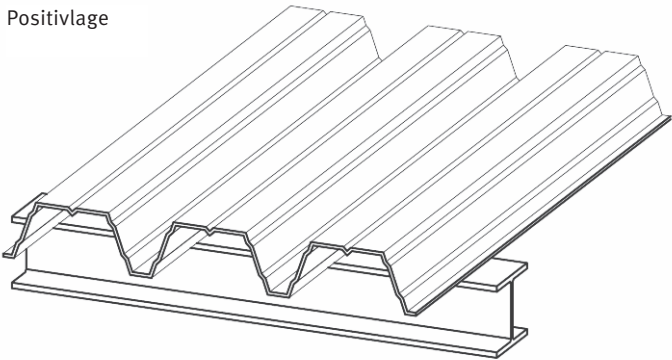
Lagebezeichnung bei Stahltrapezprofilen
